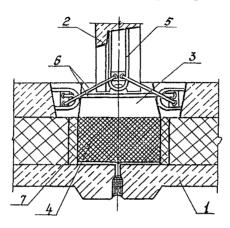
Стик трехслойных панелей наружных стен с гибкими связями, с петлевыми выпусками, заполненный бетоном и термовкладышем:
